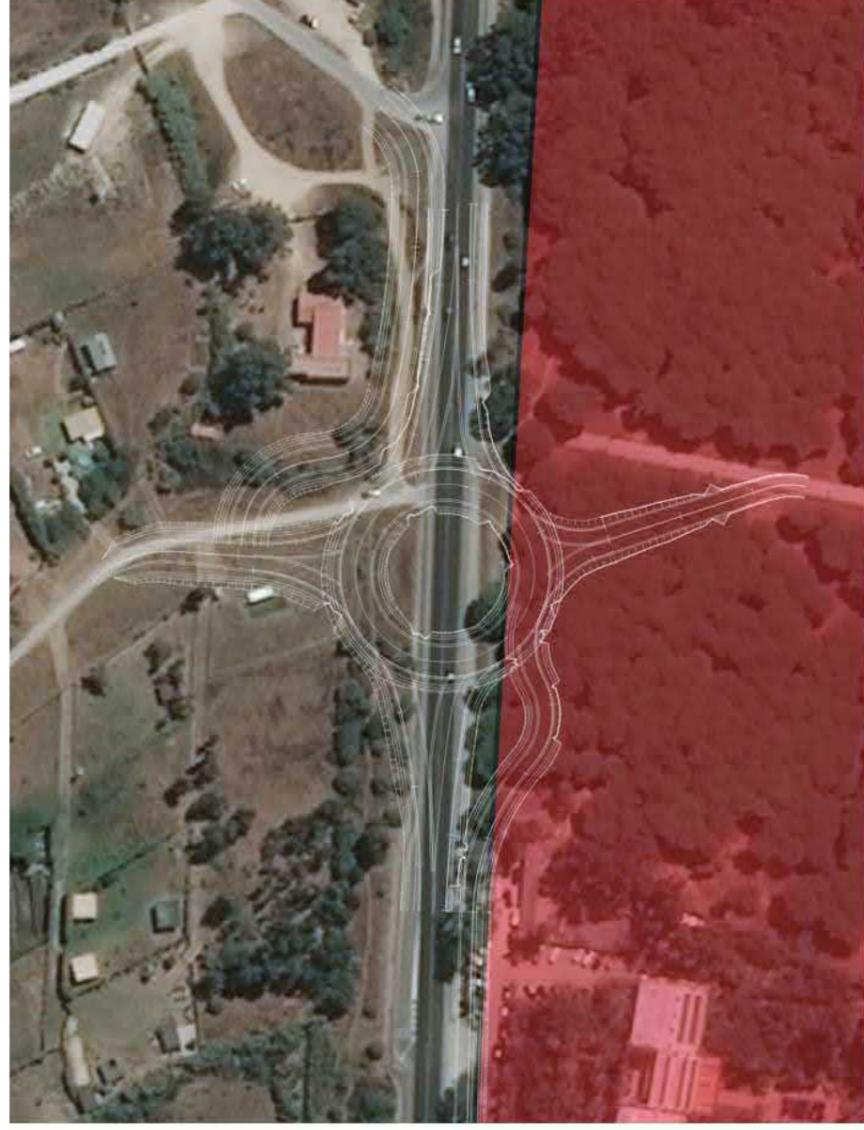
Glorieta 4. Espacio ZEPA Estrecho y planta de proyecto Sin HICs identificados
